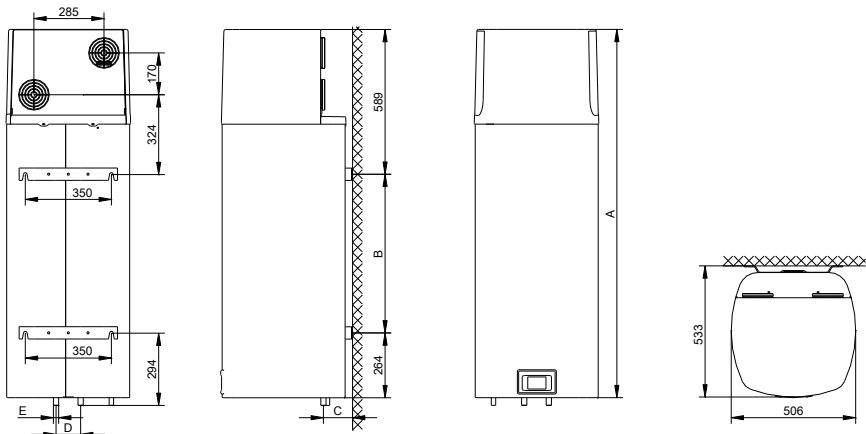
Anschluss- und Installationsmaße der Wärmepumpe (mm)
